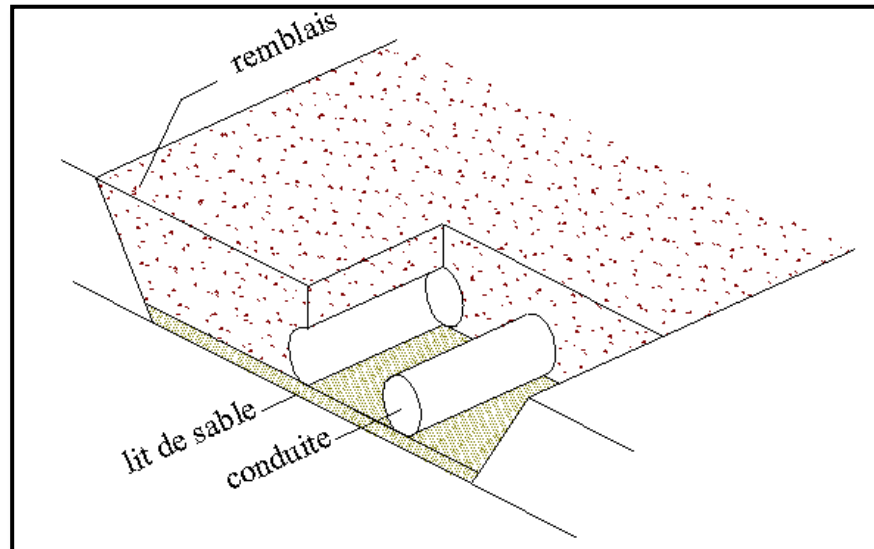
Coupe transversale d'une tranchée avec La mise en place de la conduite
